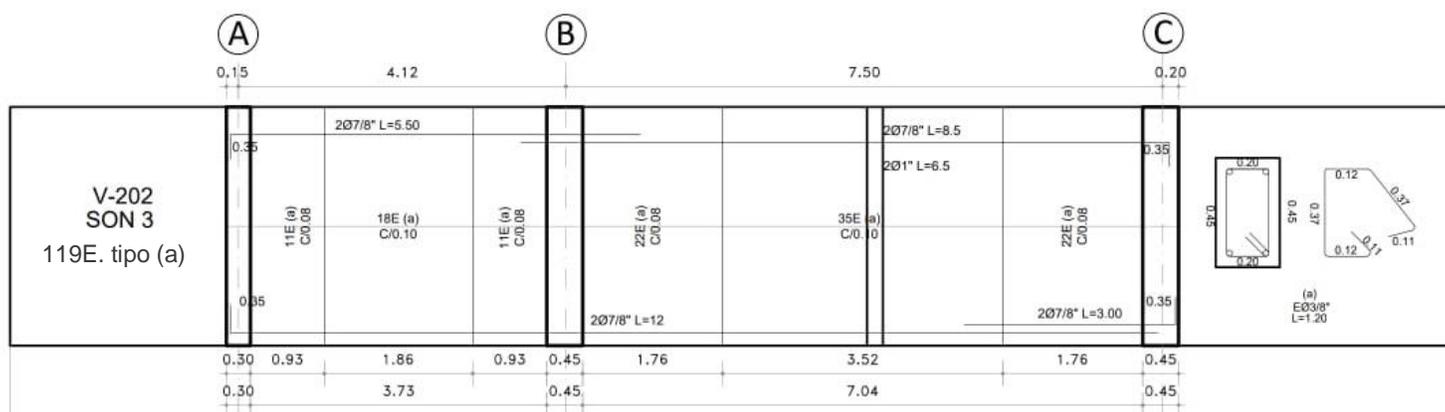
Viga 0.20x0.45 y Sección Estructural 202.
